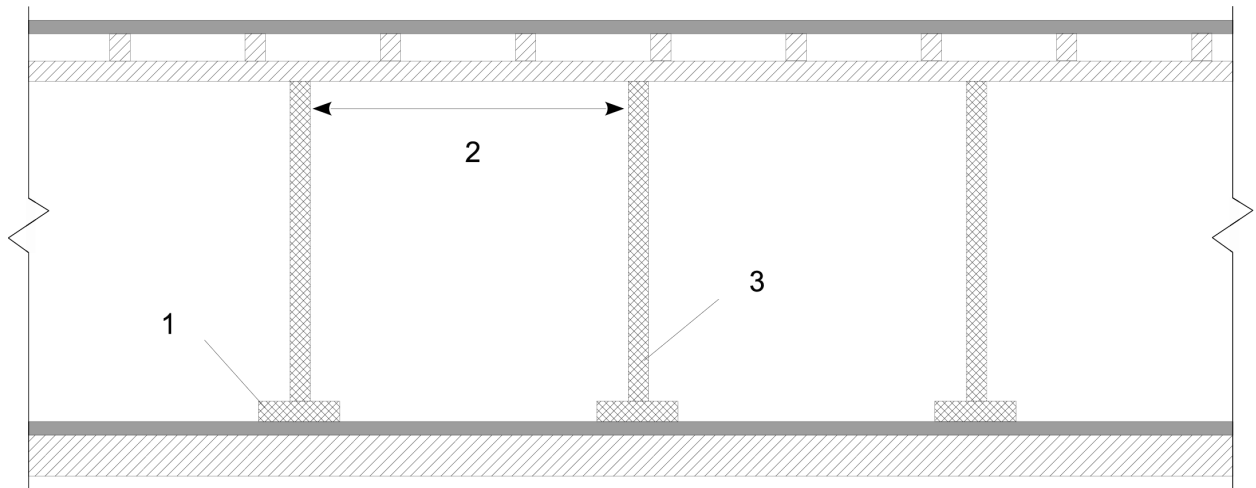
Схема конструктивного решения усиления перекрытия путем подведения снизу дополнительных опор (1 — фундамент опоры; 2 — прогон; 3 — опора)
